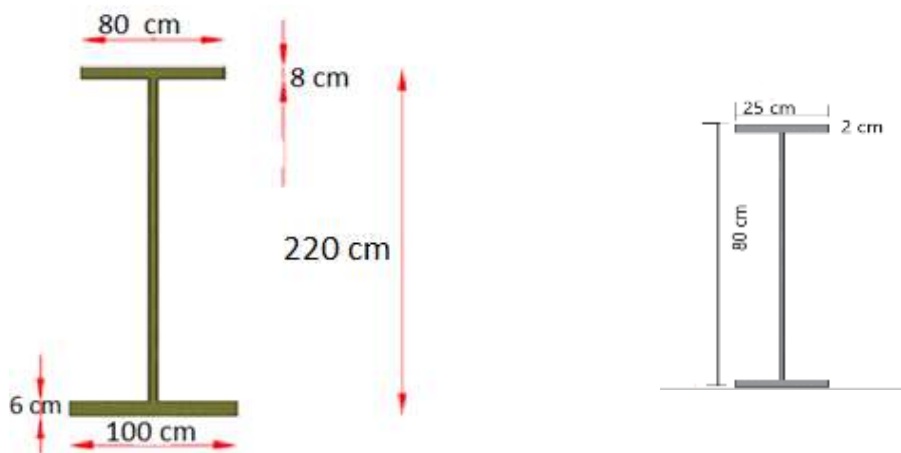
Dimensions des poutres principales et des pièces de pont.
